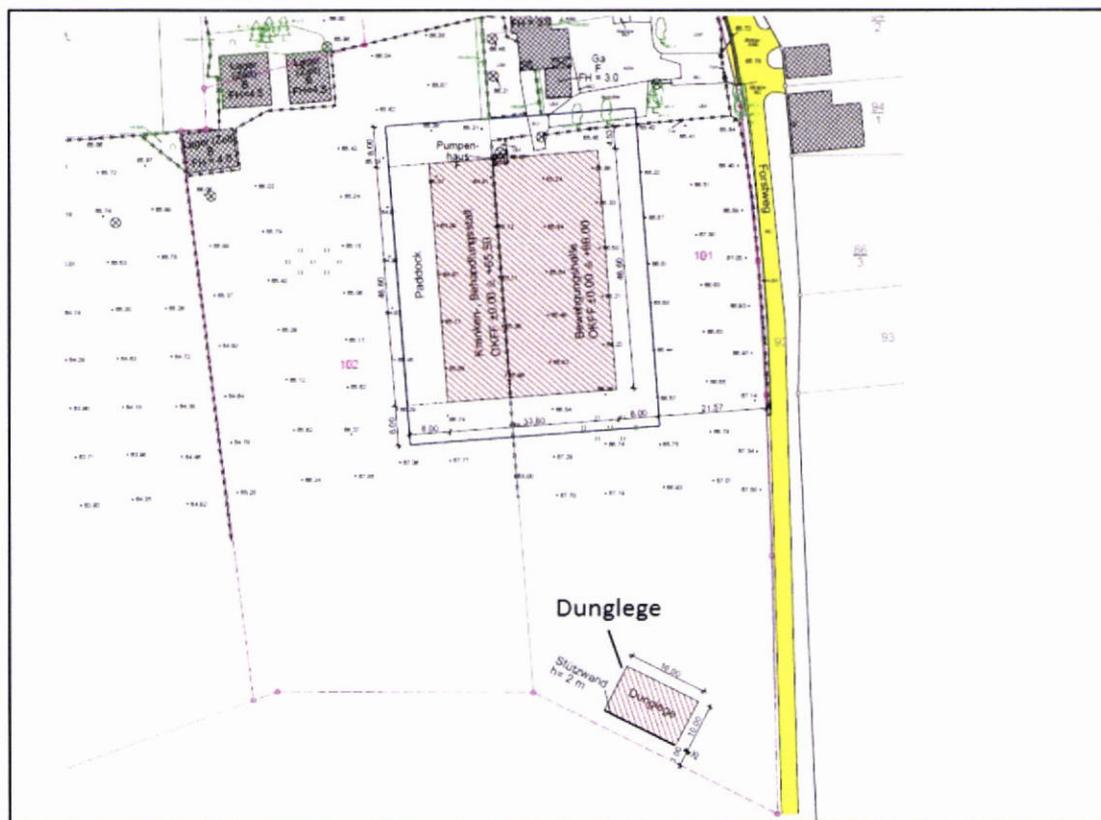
Variante 3 mit der möglichen Lage der Dunglege
